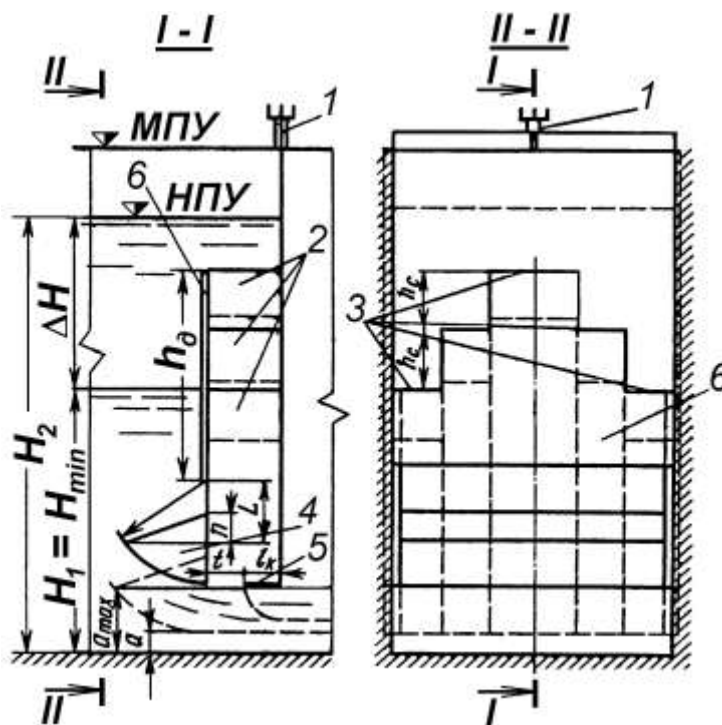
Конструкция стабилизатора расхода воды типа «Телескопический ступенчатый секционный коробчатый щит» конструкции Я.В. Бочкарёва: 1 — винтовой подъемник; 2 — коробчатый секционный аатвор рамы; 3 — водосливноя часть затвора; 4 — криволинейный козырек; 5 — горизонтальный козырек; 6 — секции.
